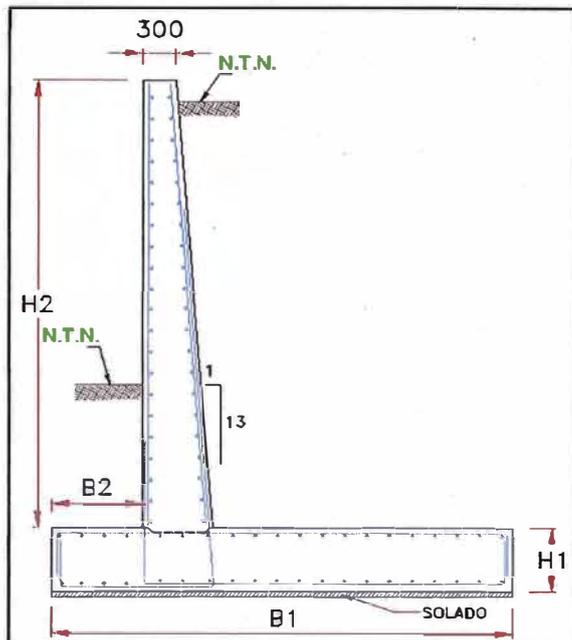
Sección típica del Muro de Contención de Concreto para cola de vía.
